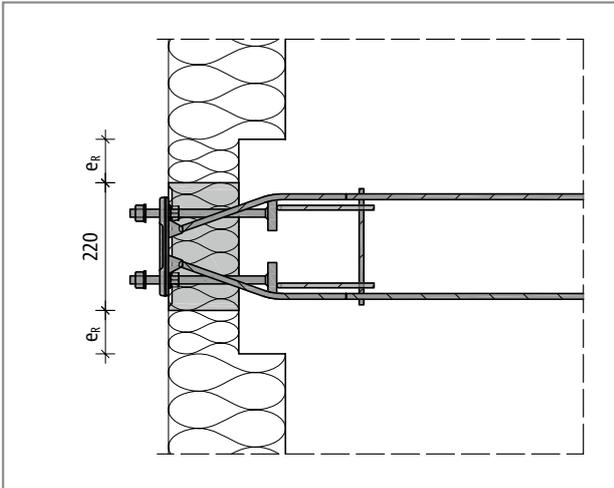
Schöck Isokorb® XT Typ SQ: Randabstände
